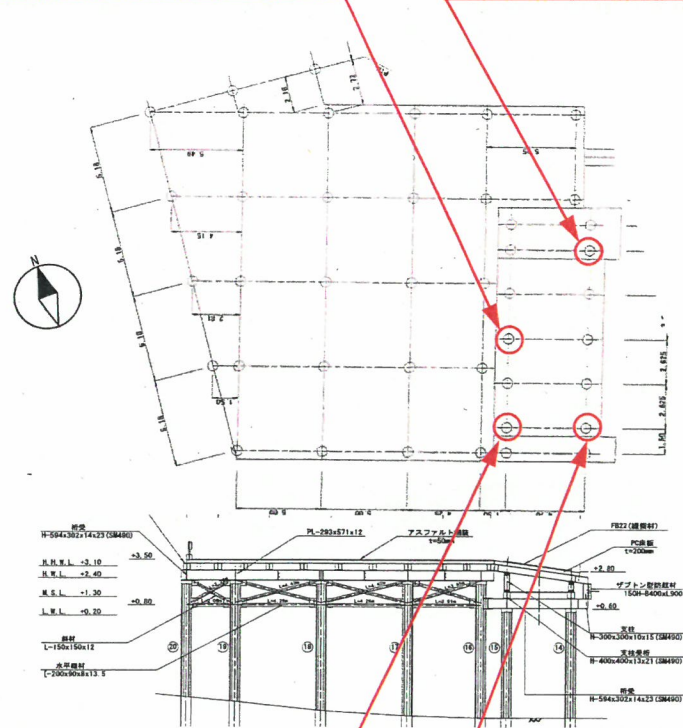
搬出入施設・車両乗降部 平面・断面図 (下部工：海水面より下)
